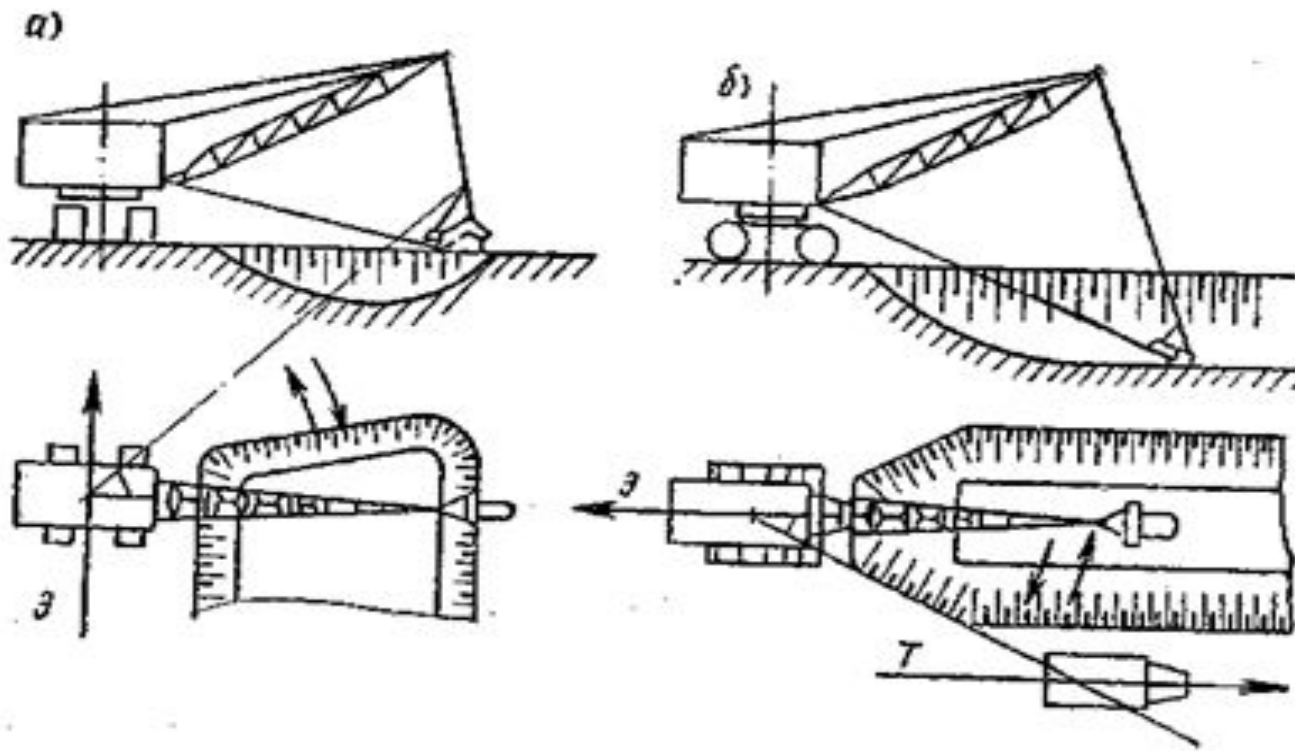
Схемы разработки выемки драглайном « — боковая проходка; б — торцевая проходка; Э и Г — оси движения экскаватора и транспорта
